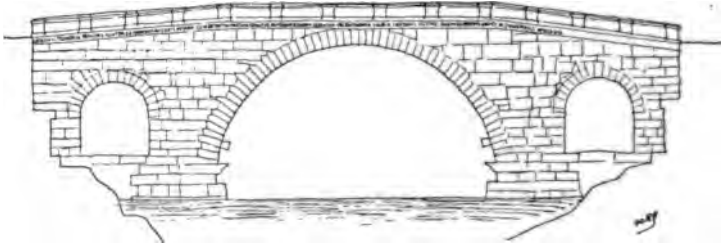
RESTAURATION DU PONT CESTIUS.
